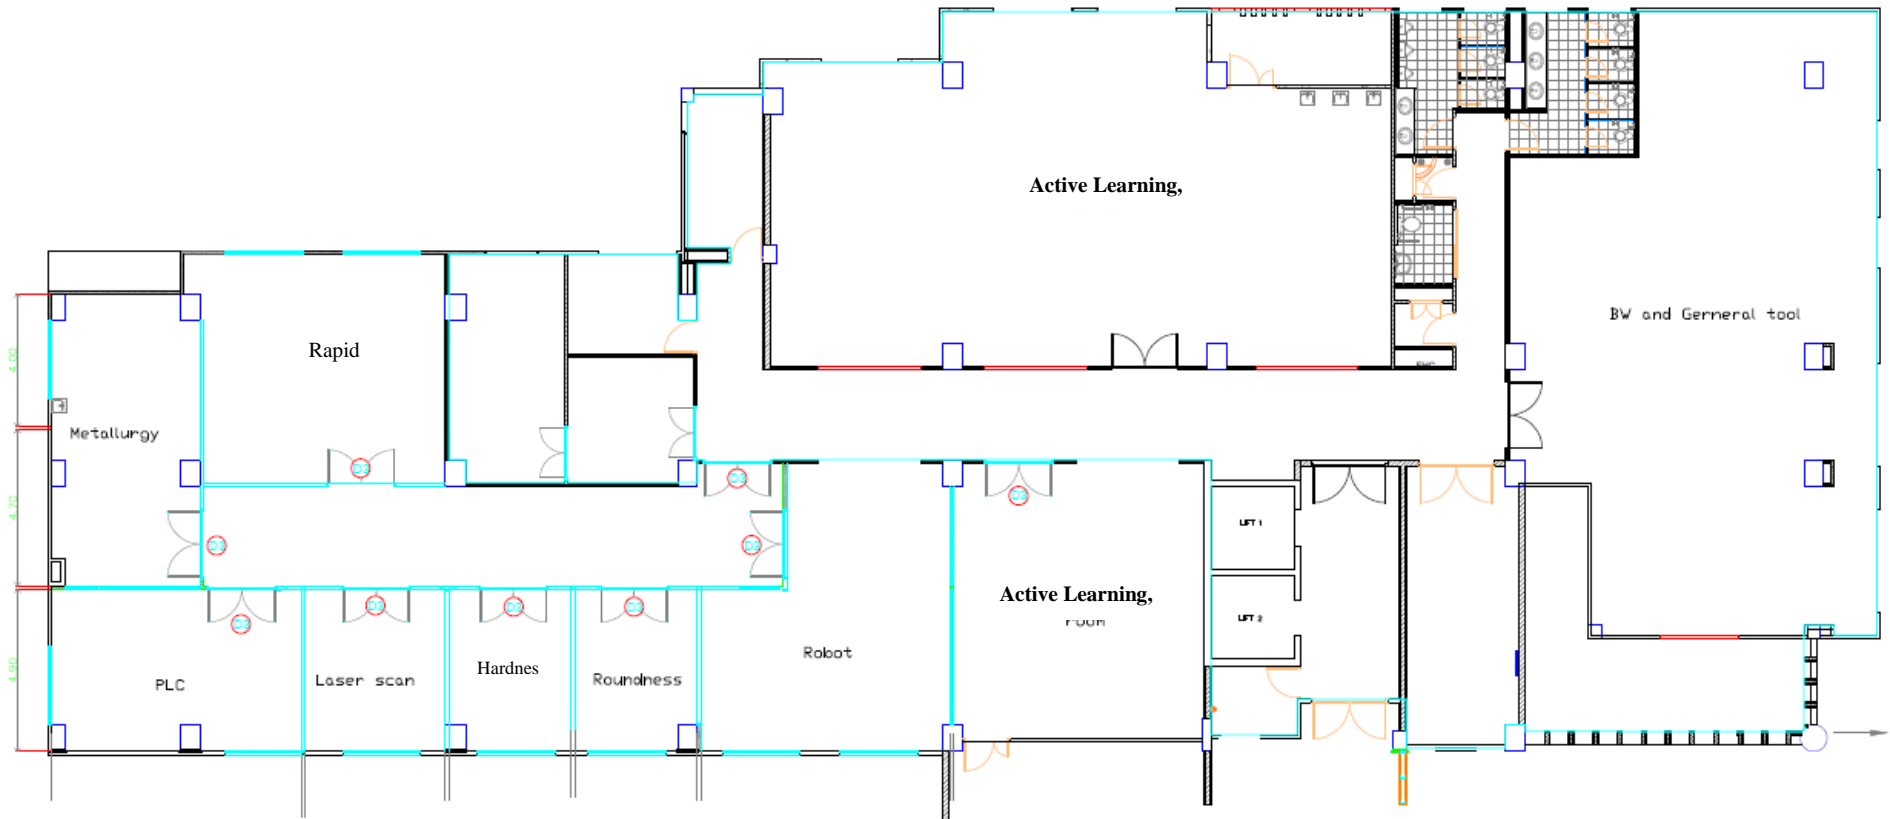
แผนผังห้องปฏิบัติการ Laser Cut Machine and Robot Kuka
